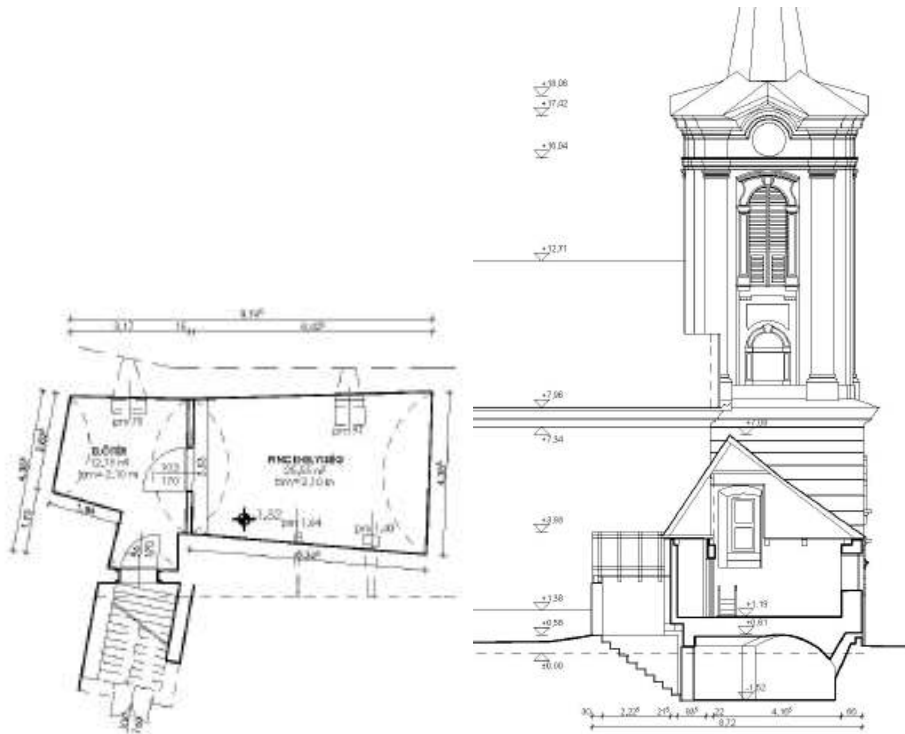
Stânga: Plan subsol, Dreapta: Secțiune transversală - parohia romano-catolică din Sic- BME
